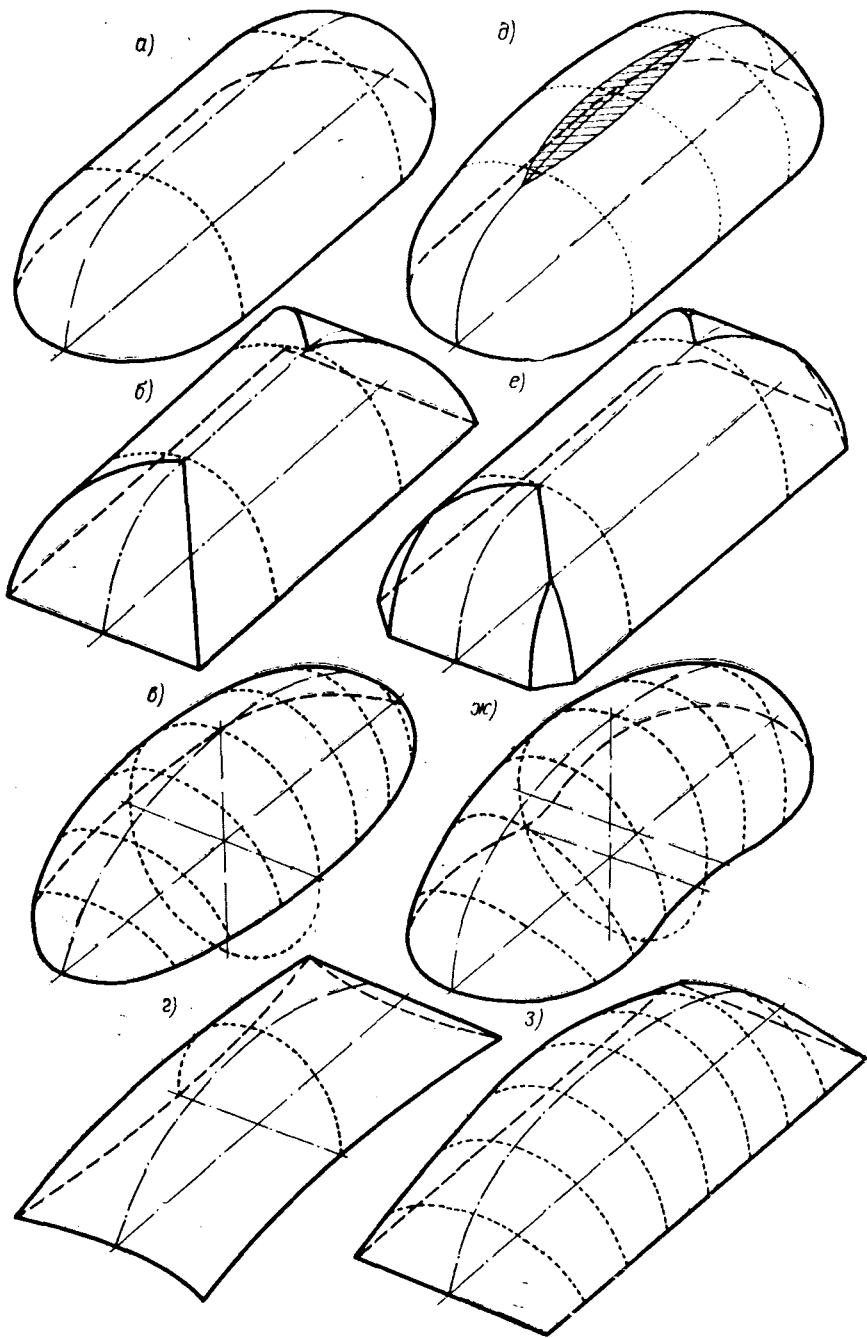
Формы оболочек, перекрывающих прямоугольный или овальный план
